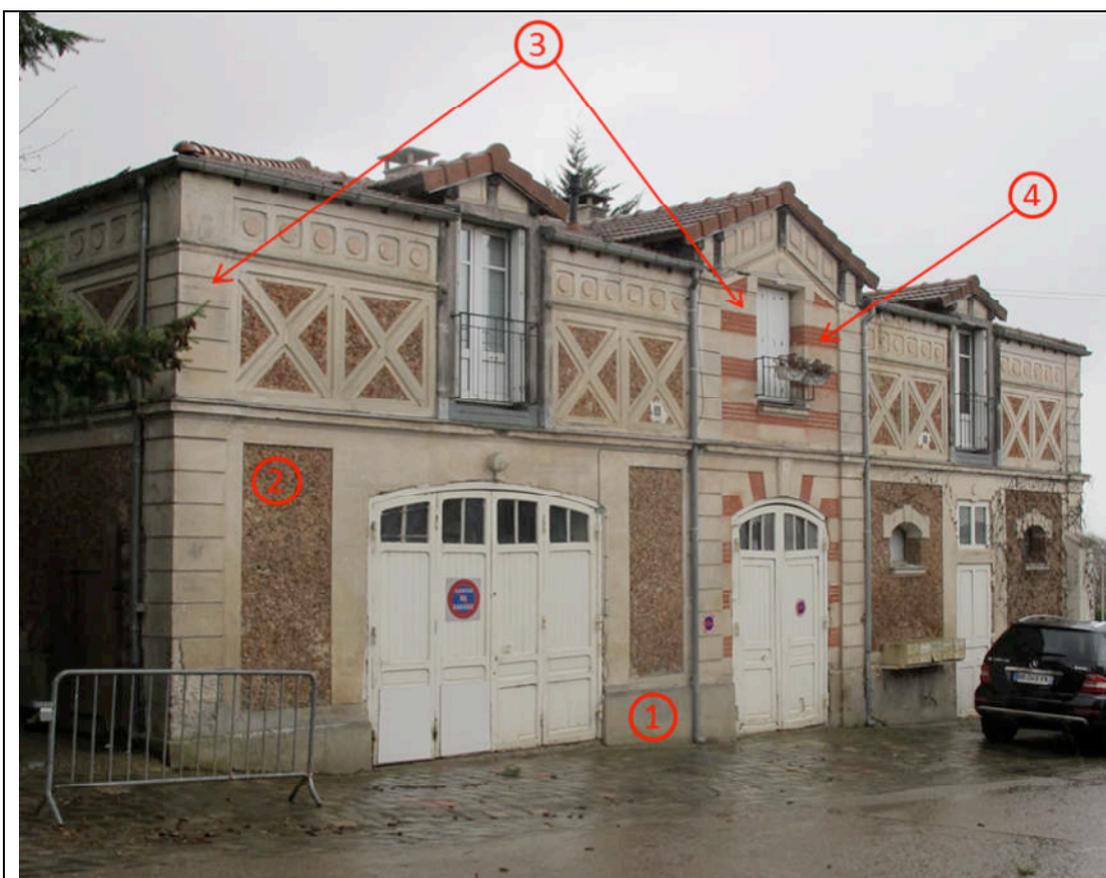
Différents enduits, bâtiment Ouest, Façade Est.
